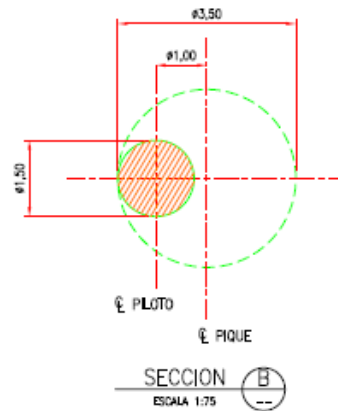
Corte sección del pique de traspaso con piloto- Esmeralda
